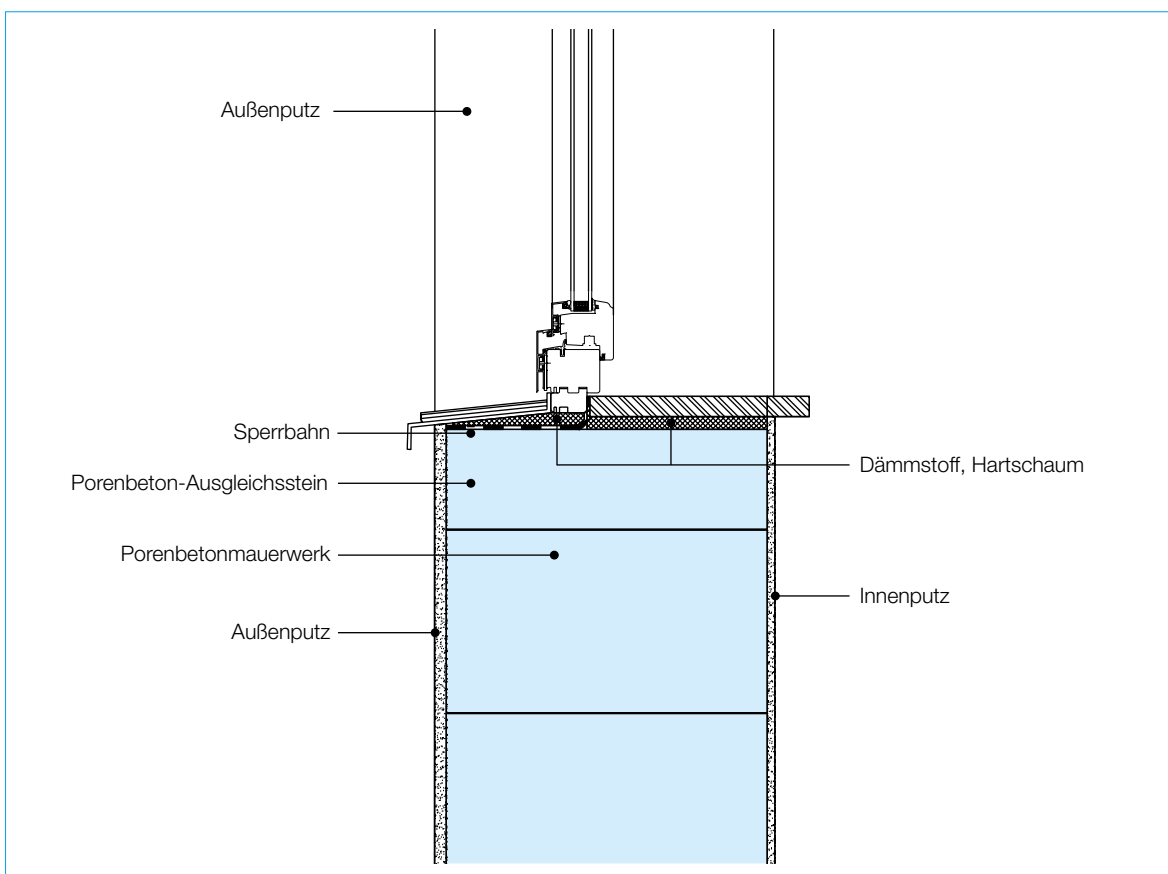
Einschalige Außenwand aus Porenbetonmauerwerk – Fensterbrüstung
